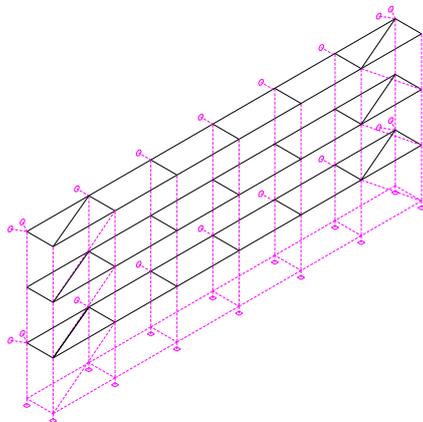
Contreventement horizontal en cas de plateformes à planches en bois
